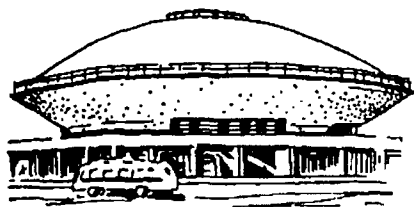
Гладкий железобетонный купол с опорной чашей цирка в Казани.
